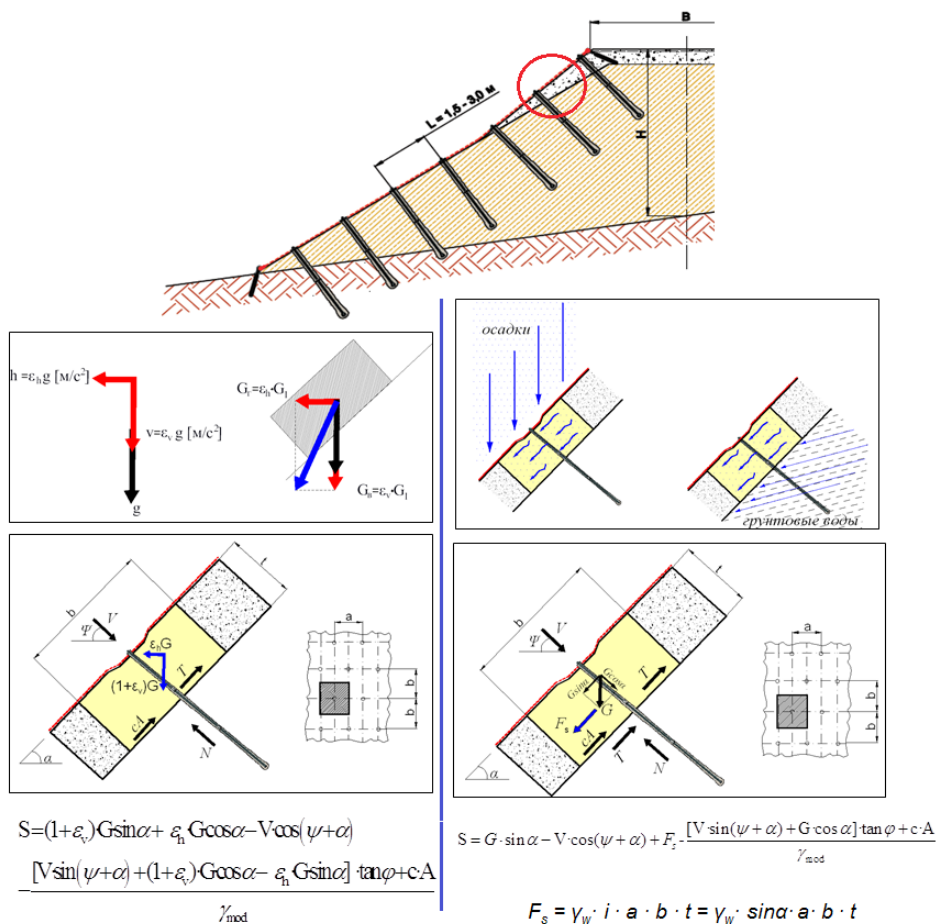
Расчётные схемы для усиления земляного полотна железных дорог анкерными и нагельными конструкциями.
